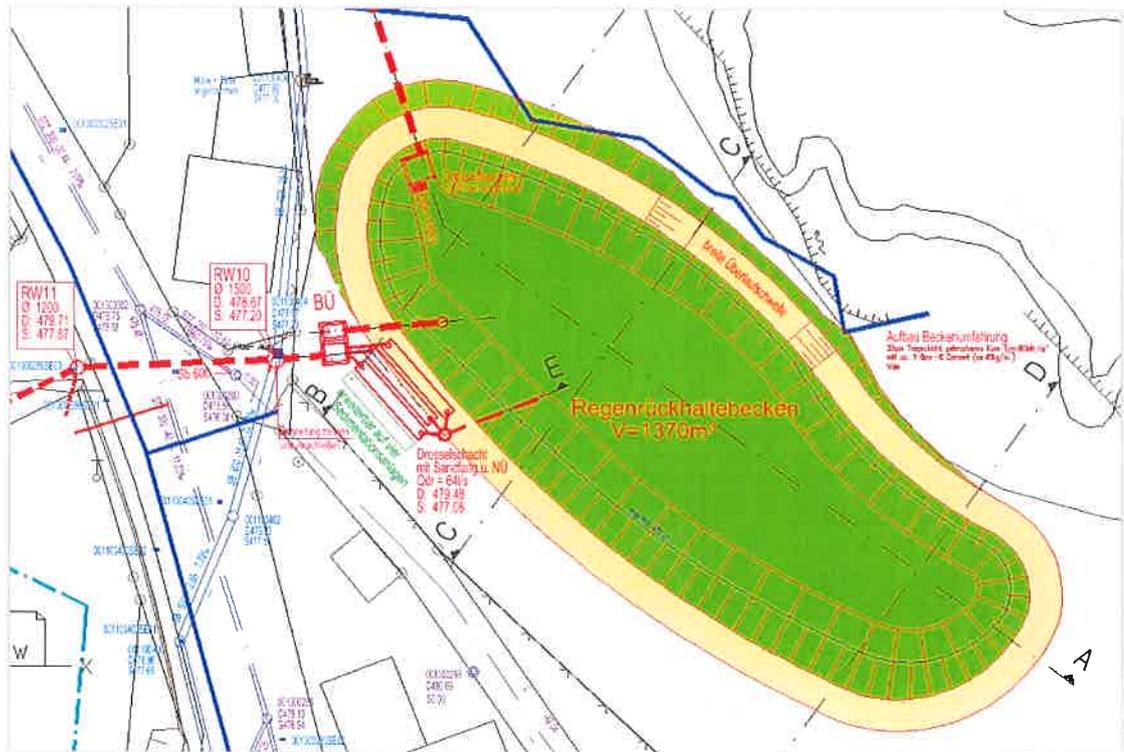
Ausschnitt Lageplan – RRB mit 1.370m³ Rückhaltevolumen
